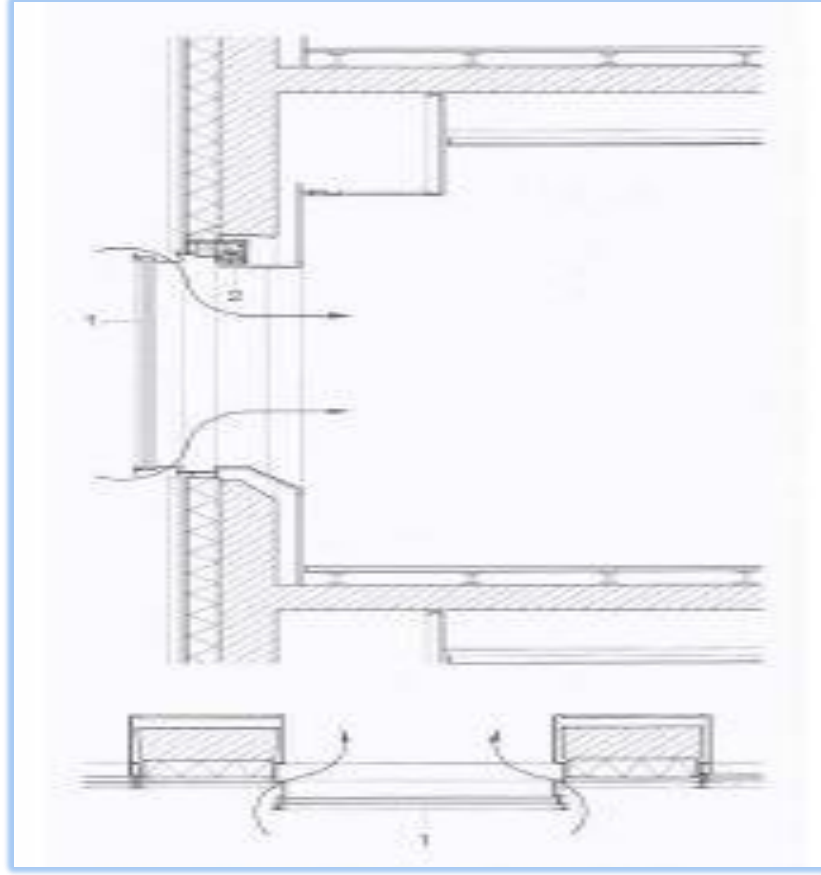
Trump Towers Açılabilir Pencere Detayları
